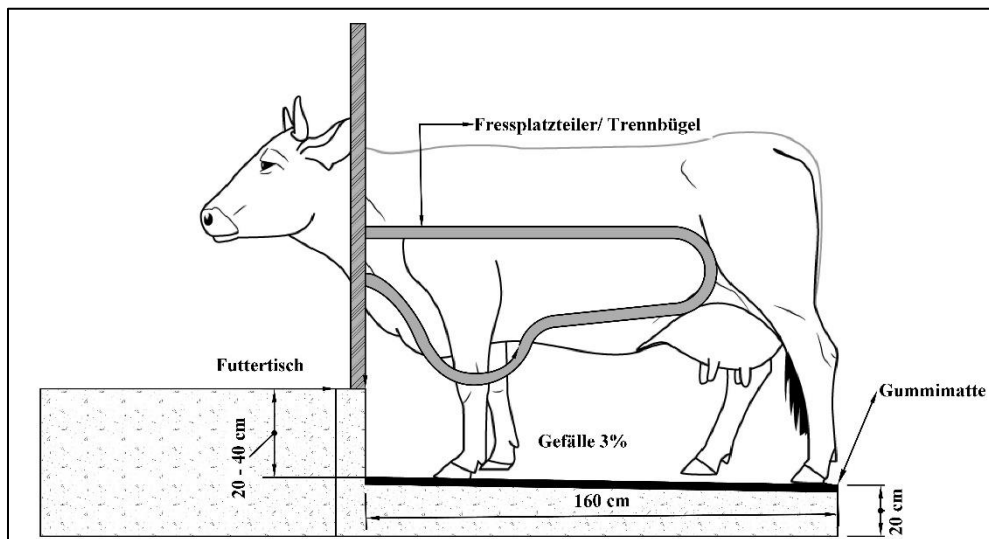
Bauliche Ausführung eines erhöhten Fressstandes mit starrem, freitragendem Fressplatzteiler
